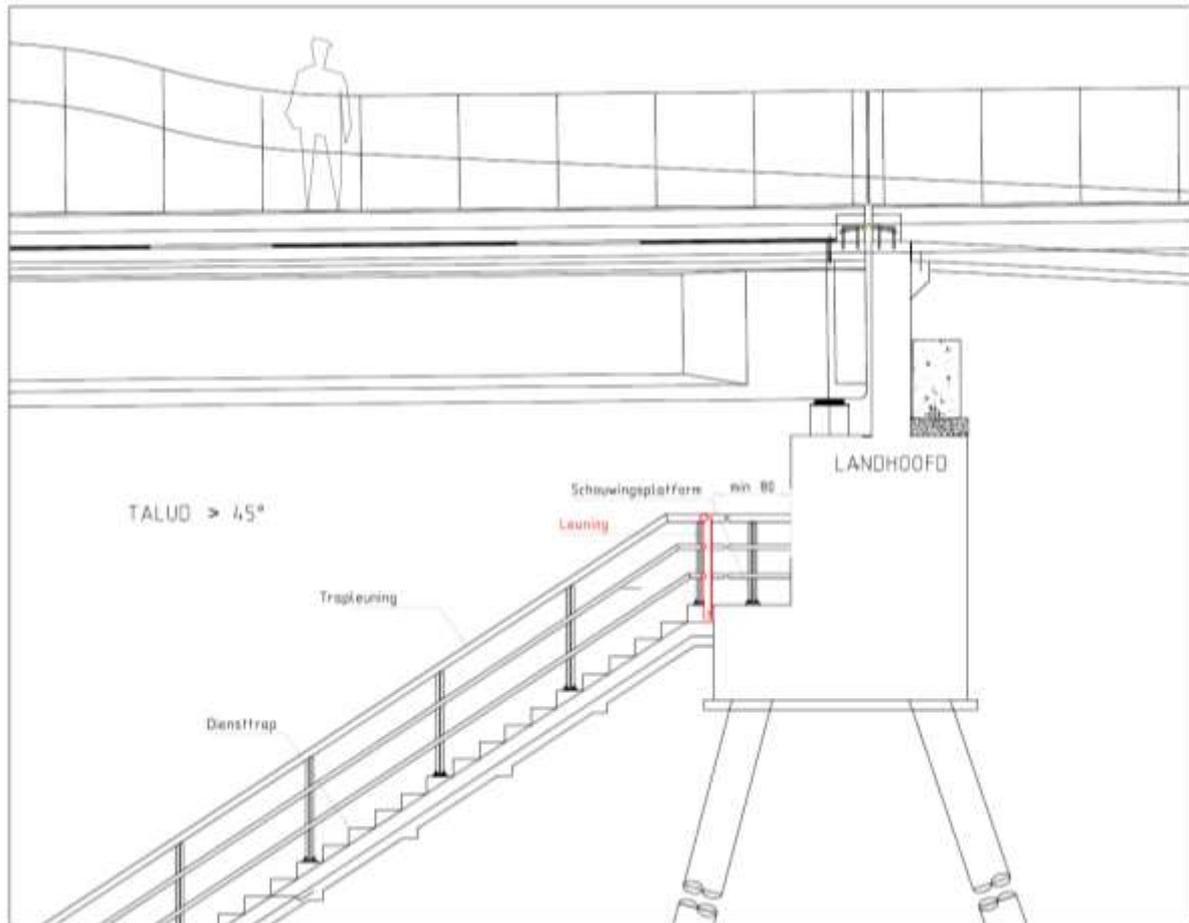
Plate-forme d'inspection de culée noyée en cas de talus raide
